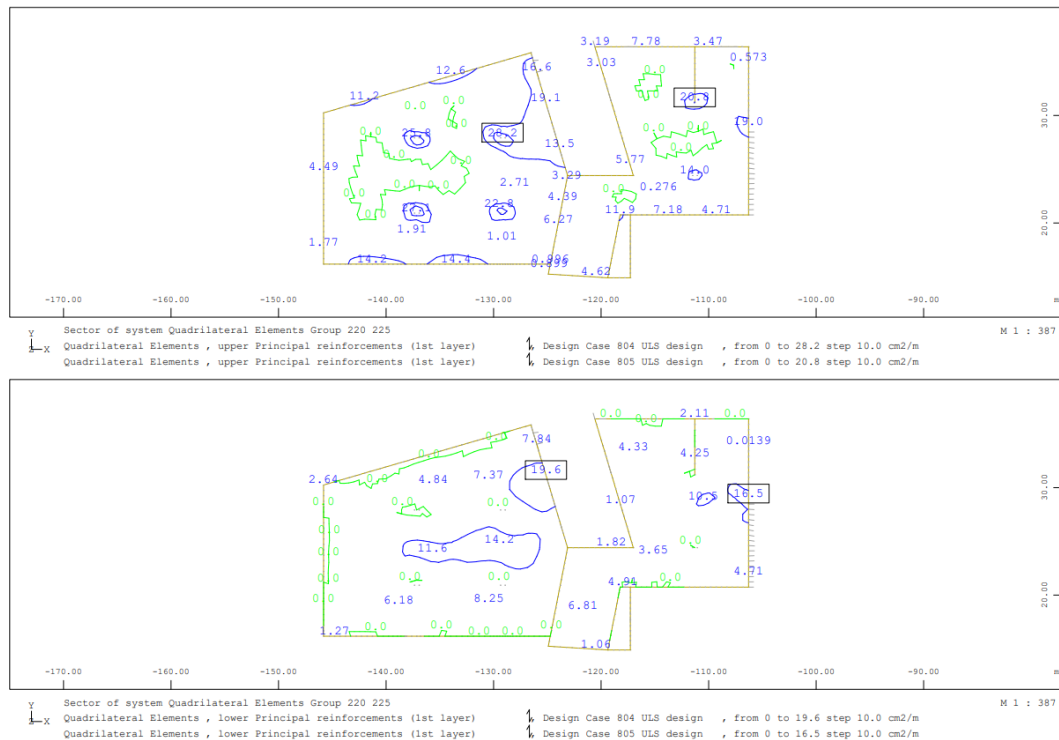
Armadura principal na face superior (sup.) e inferior (inf.) – laje intermédia – acesso Norte - ELU
